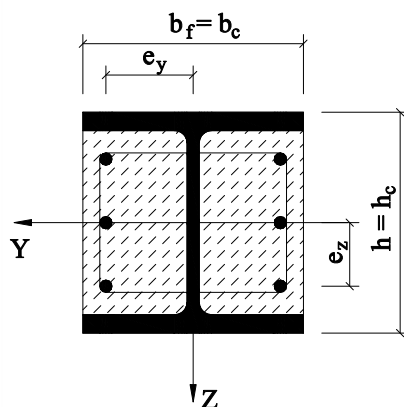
Сечение сталежелезобетонной колонны
